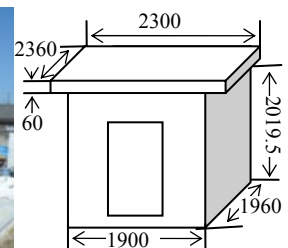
実証実験風景 図-2 建屋寸法 (mm)
